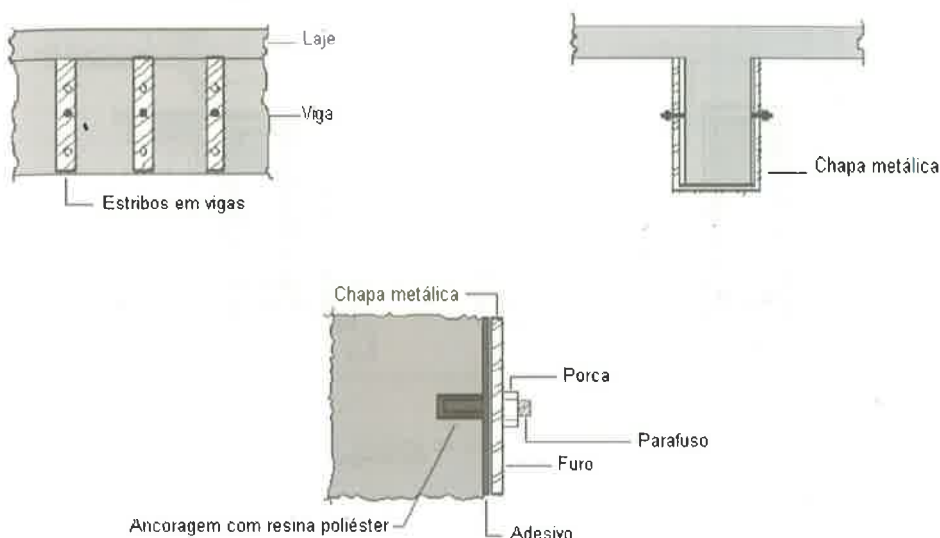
Reforço de cortante em vigas com chapas metálicas aderidas com epóxi.
